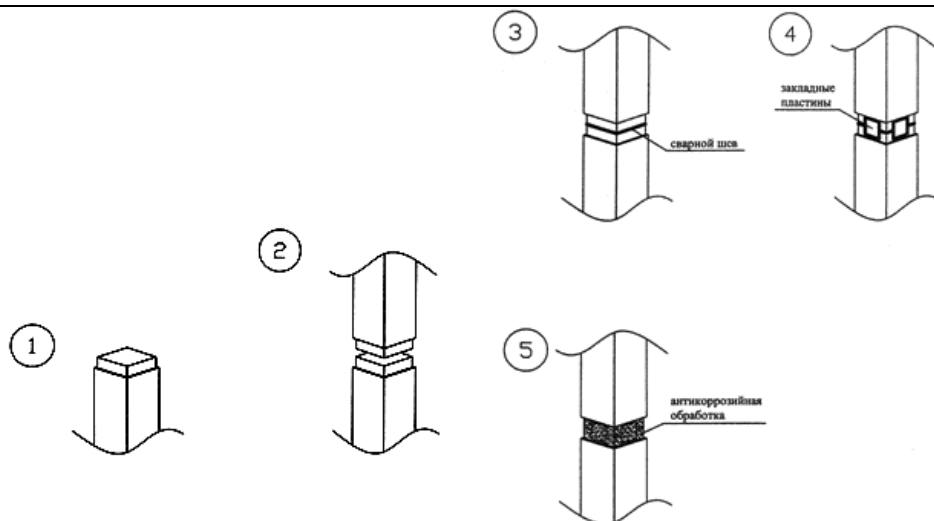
Схема сварного соединения стыка составной железобетонной сваи
